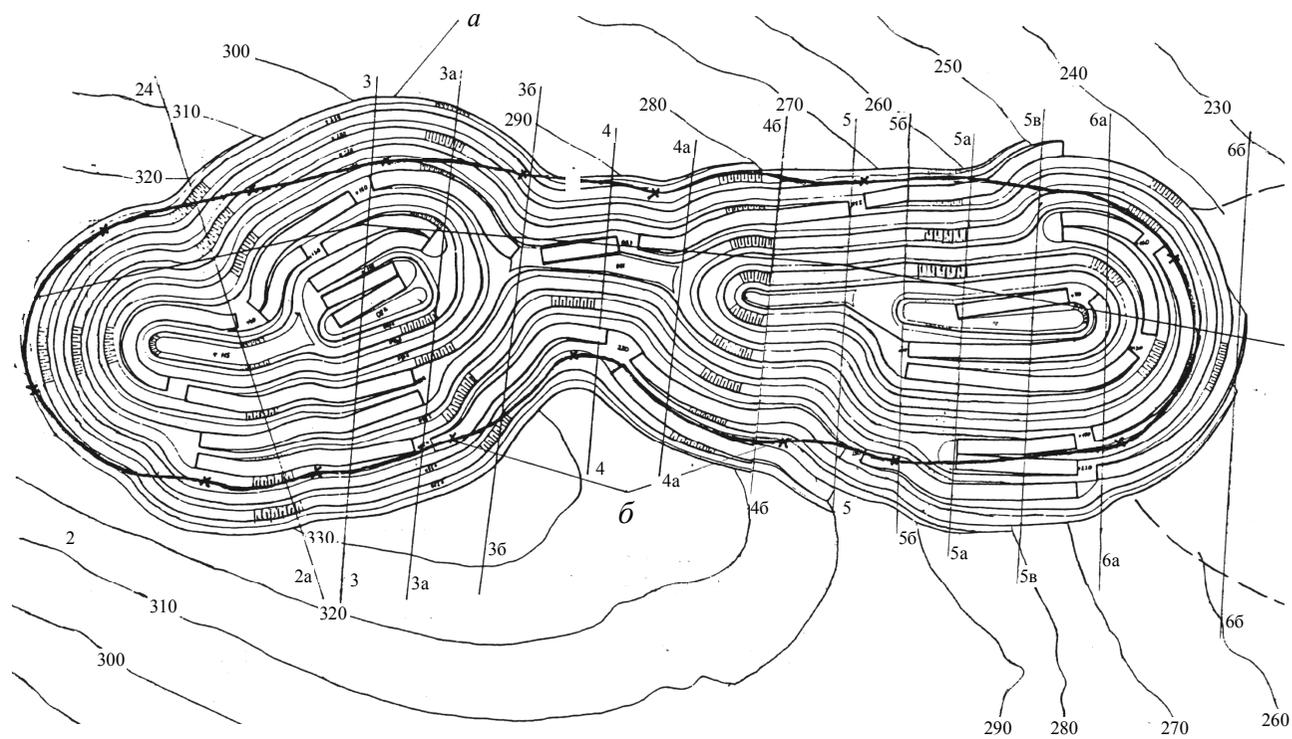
План карьера им. XV-летия Октября на конец отработки со схемой (а) и без схемы (б) вскрытия
